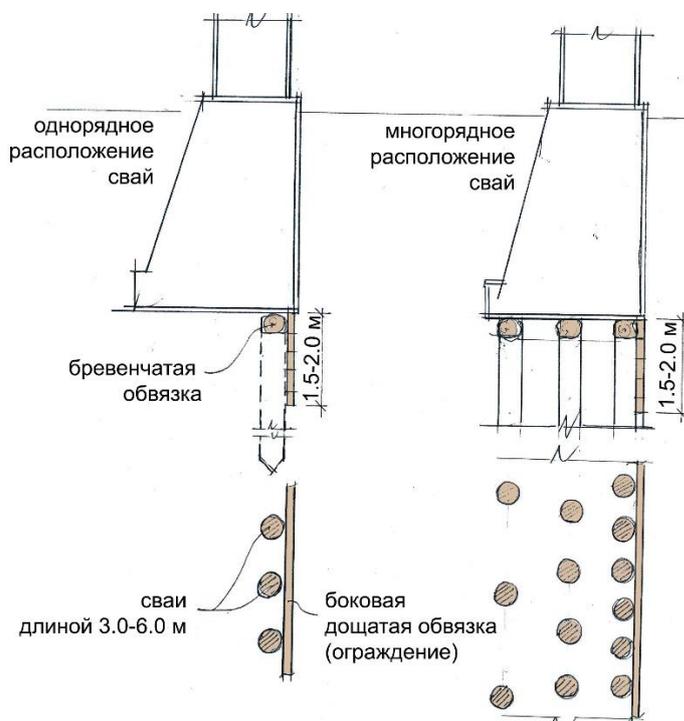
Свайное усиление оснований с устройством боковой дощатой обвязки свай
